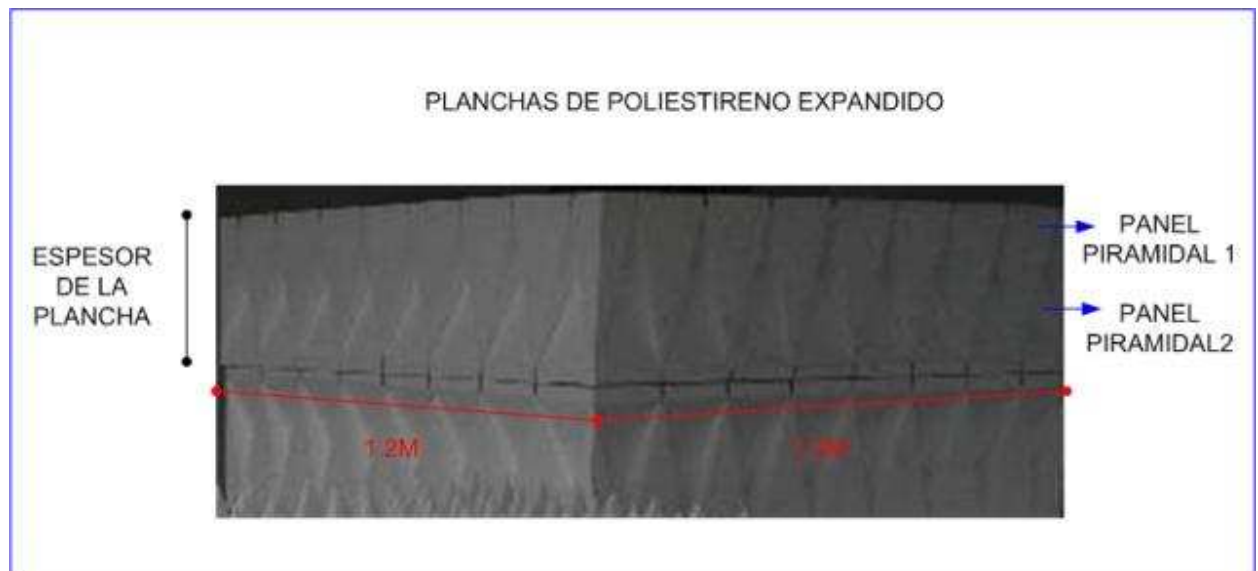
Las planchas de poliestireno expandido contienen dos paneles piramidales
